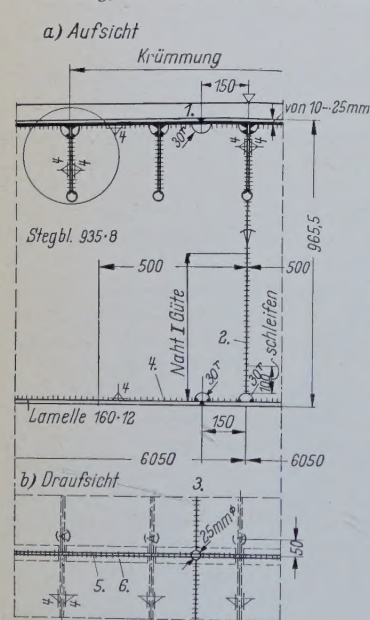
Schweißtechnische Ausbildung des Querträgers.
